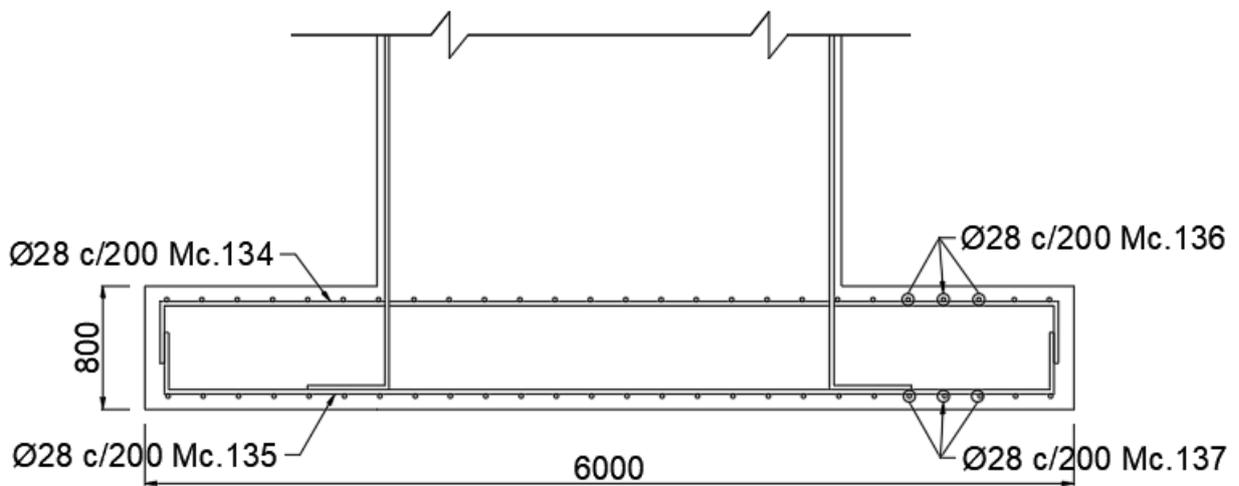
Sección transversal de la zapata, corte B-B´ [Elaboración propia]
